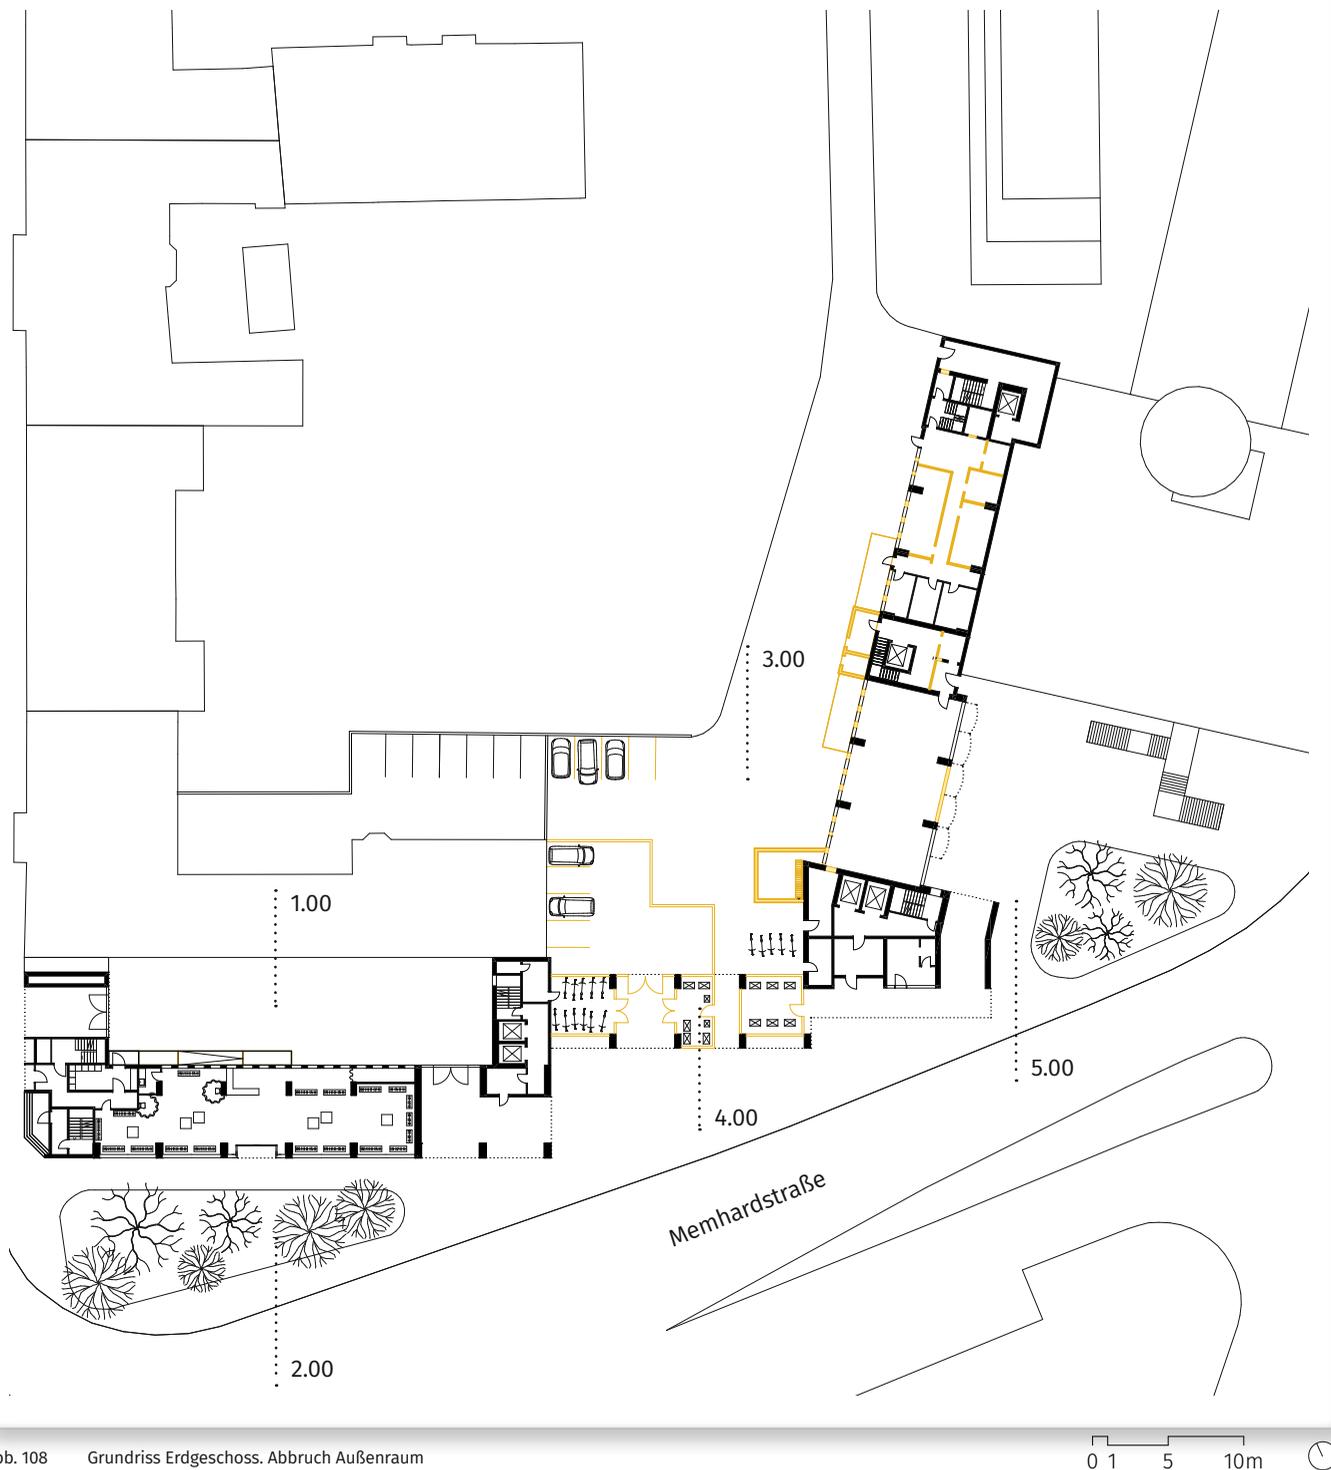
Grundriss Erdgeschoss. Abbruch Außenraum
